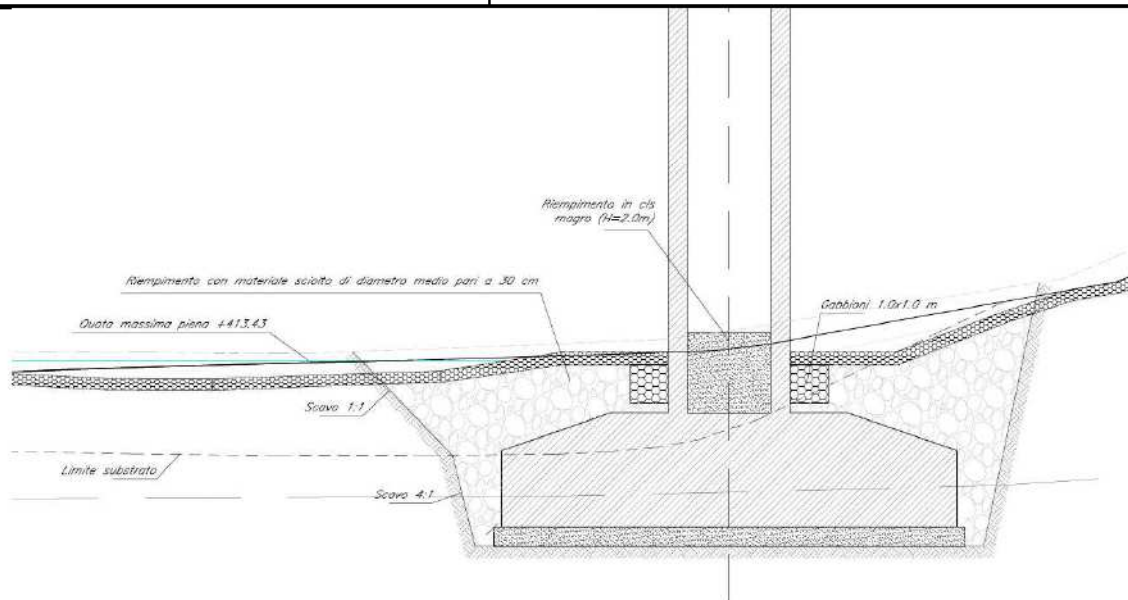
VI01 – PARTICOLARE DELLA SEZIONE LONGITUDINALE CON PROTEZIONE DELLA PILA DAI FENOMENI DI SCALZAMENTO.
